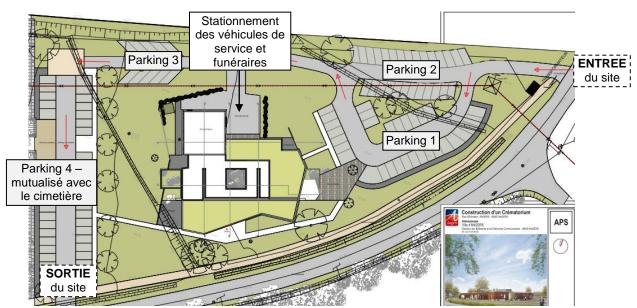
Plan de circulation des usagers sur le site du crématorium
